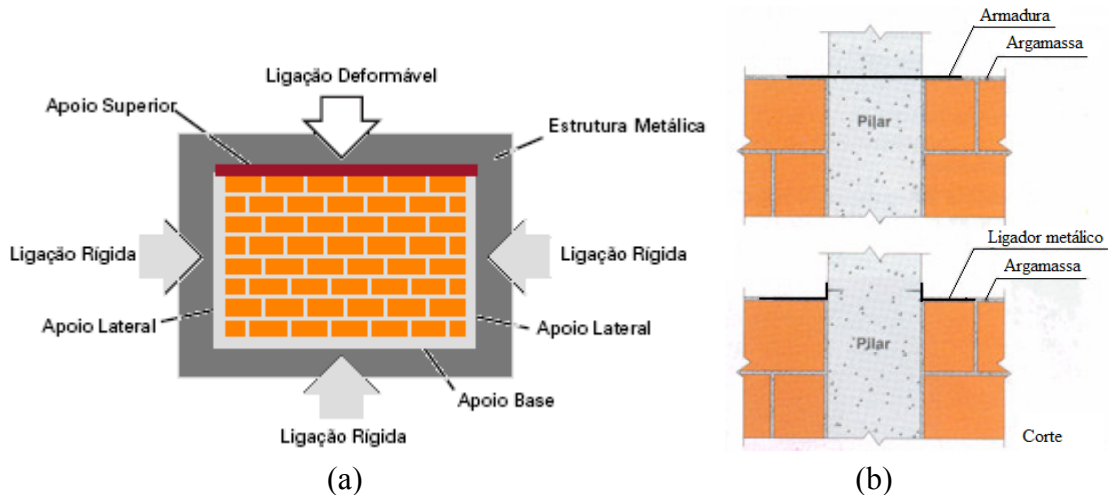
(a) Sistema semi-rígido de ligação parede / estrutura e; (b) detalhes de ligadores entre pilar e alvenaria (adaptada de NASCIMENTO, 2004 e PEREIRA, 2005).
